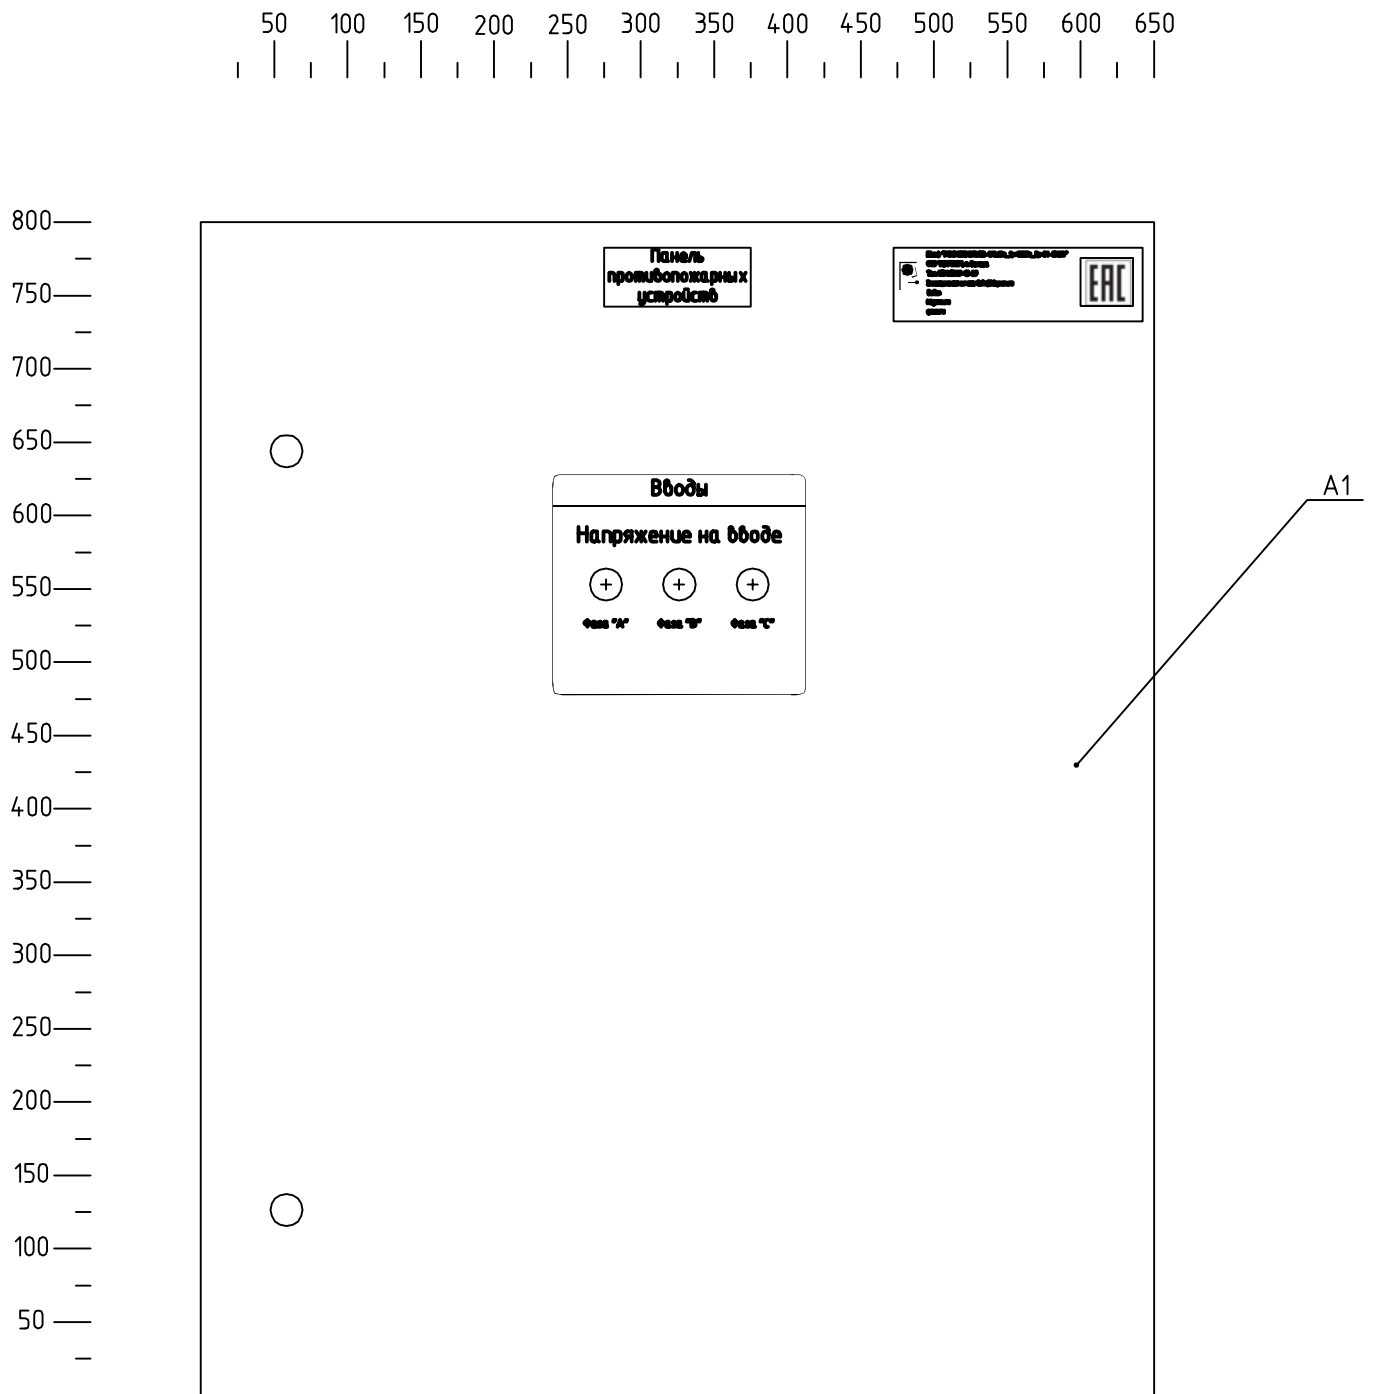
Шкаф "ГОХО ППУ Я.Г.2", вид спереди на фасад (М 1:5)
